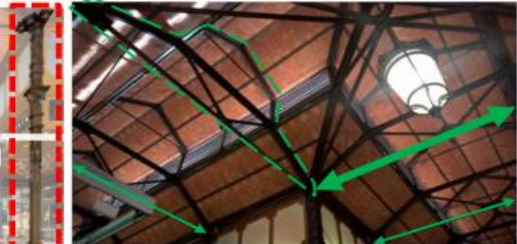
Vista interior del Mercado de San Miguel. 2015.
